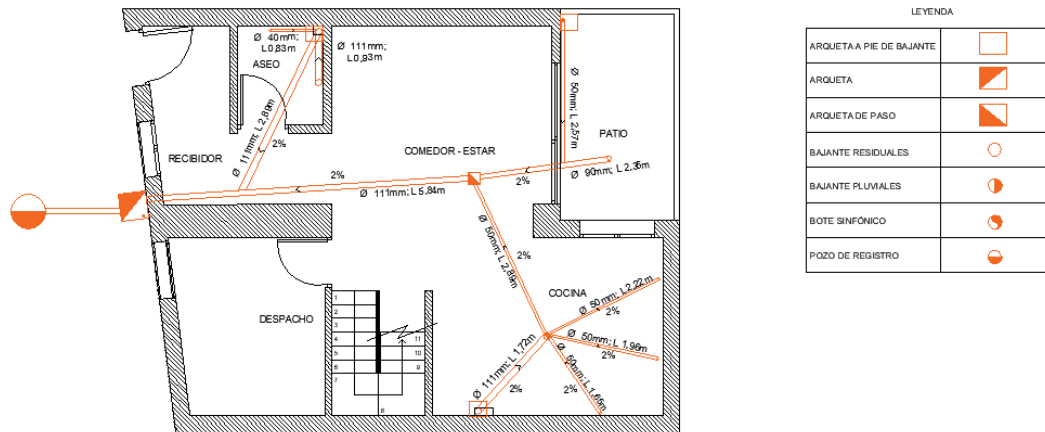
Red de pequeña evacuación planta baja. Fuente propia
